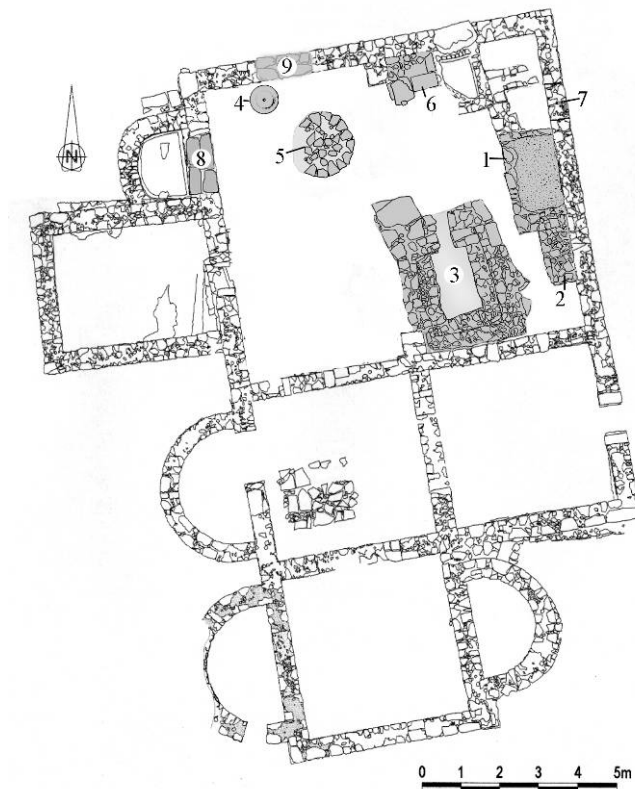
Planta do edifício das Termas Sul. Estruturas da 4ª fase.
